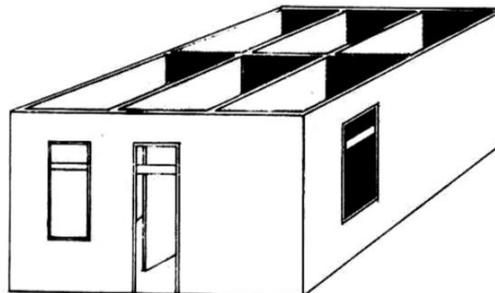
Denah Bangunan Gedung yang Terdiri dari Rangkaian Bangunan Simetris
